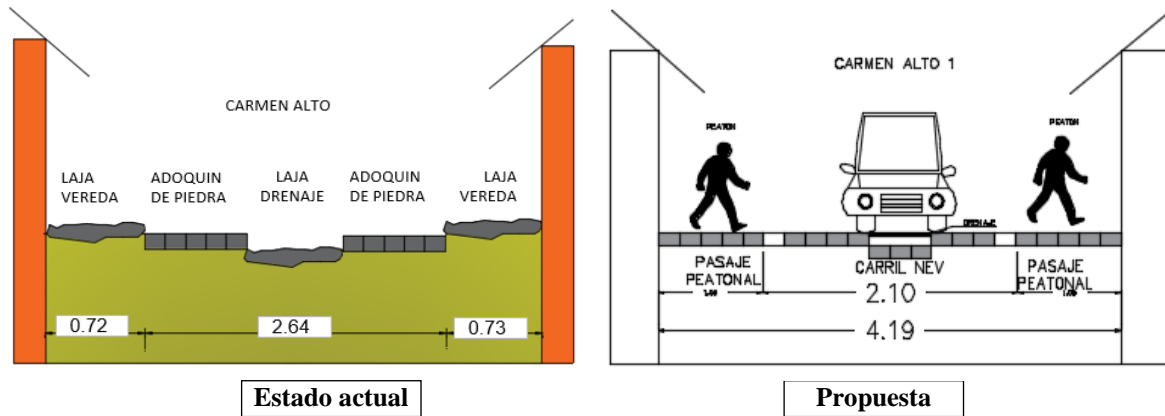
Propuesta de la sección transversal para la calle Carmen Alto 1
